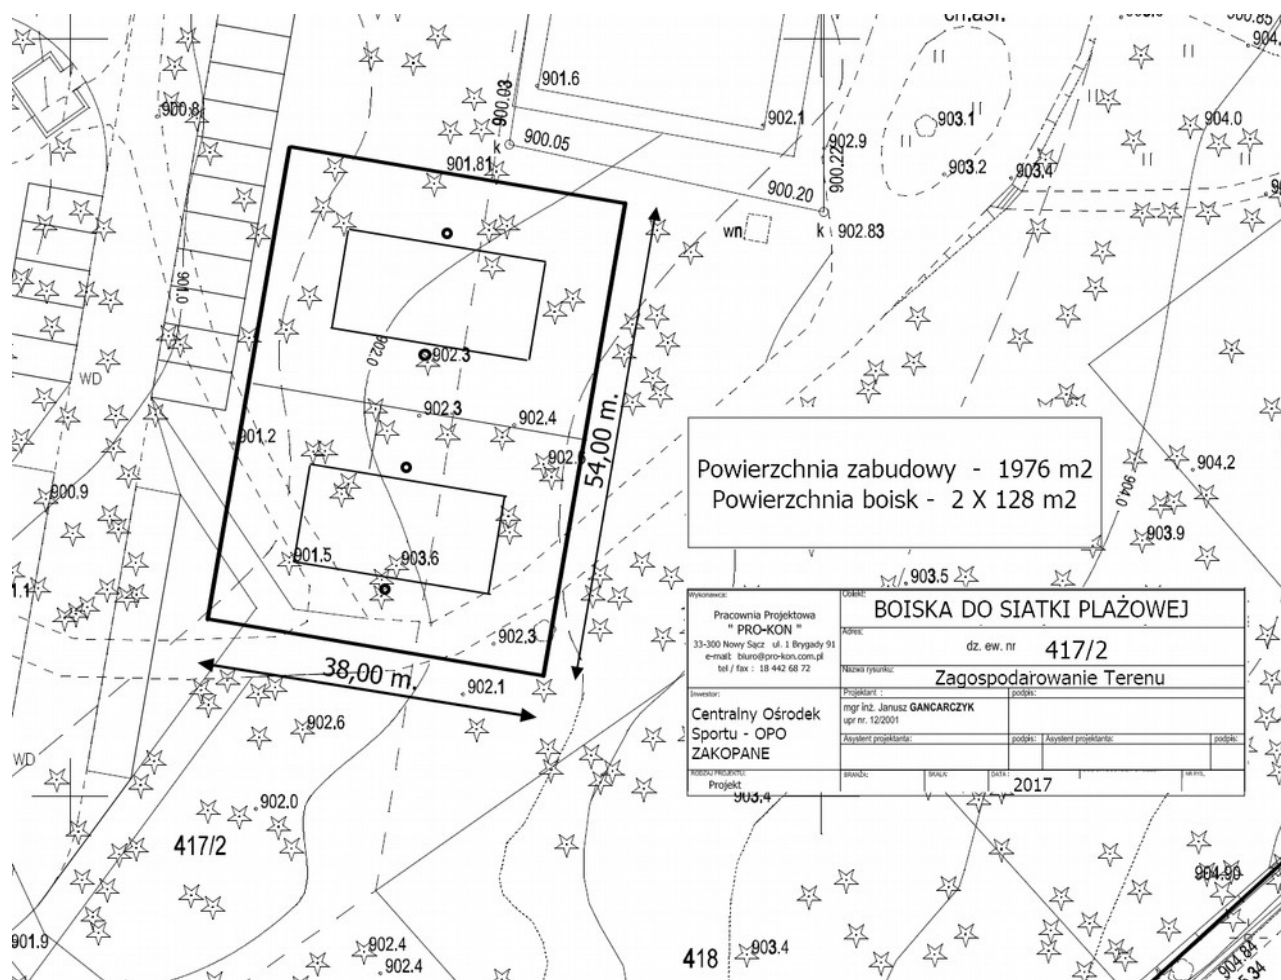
Zdjęcie Teren pod planowaną budowę
